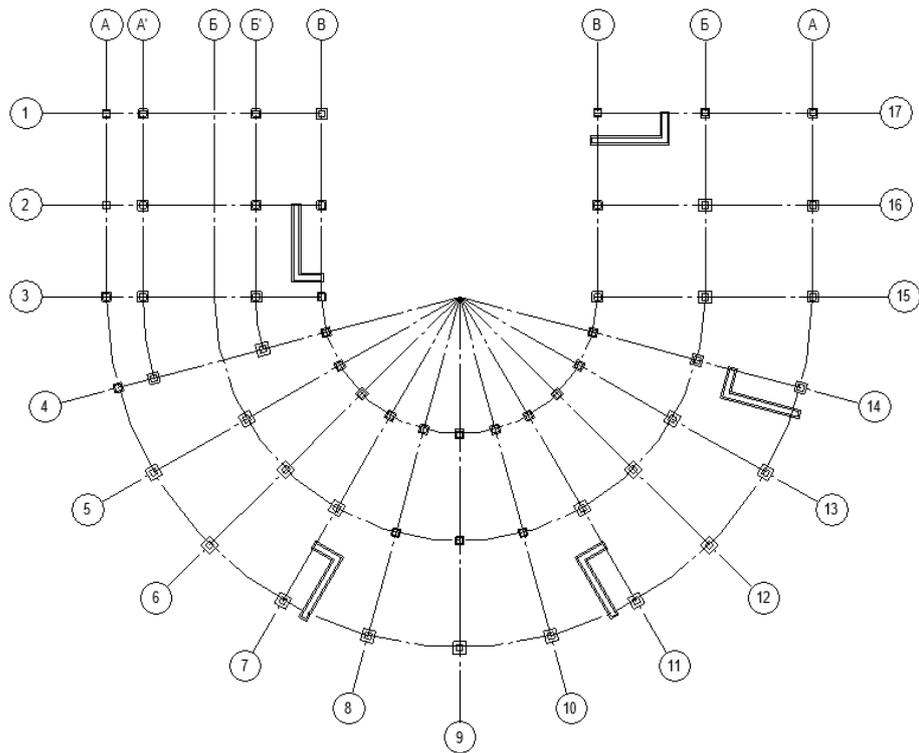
План расположения фундаментов на отметке -5,060м
